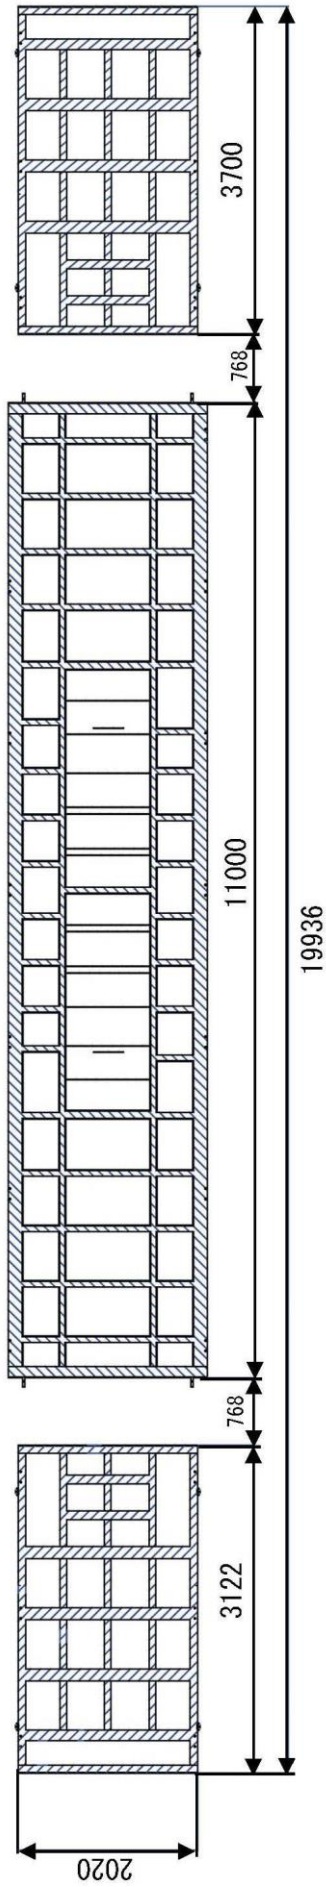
パワーコンディショナー架台 (平面図)
